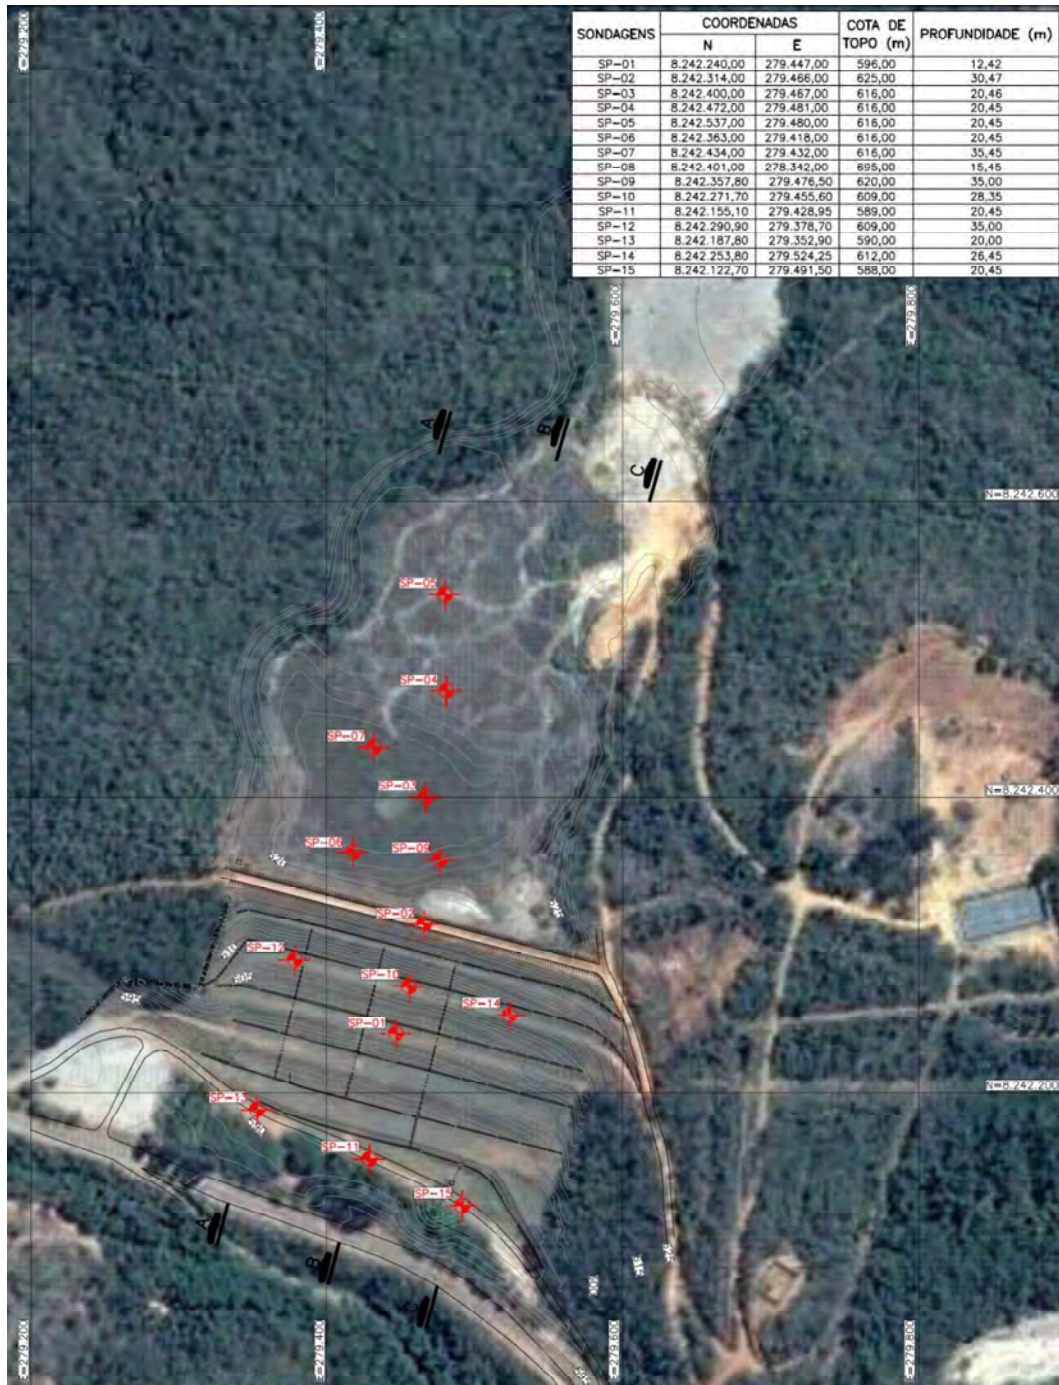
Planta de locação das investigações – Barragem Marçu (CAR-E-PM-RE-001-0).
